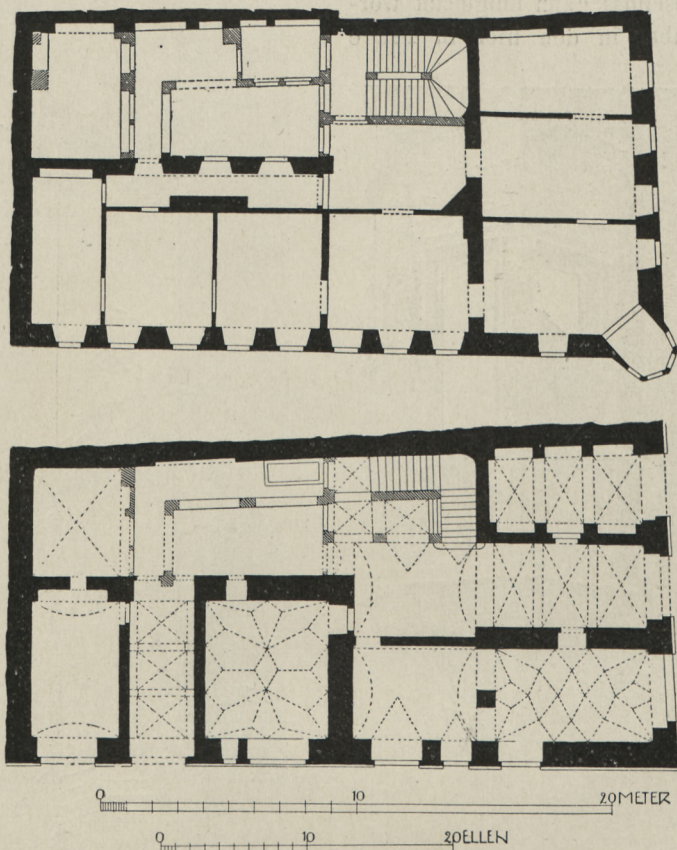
und 479. Wilsdrufferstrasse Nr. 2. Grundriss des Erd- und ersten Obergeschosses.
